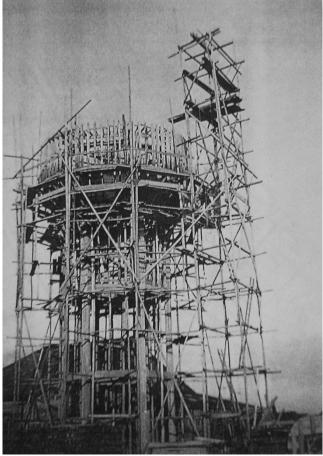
La construction du château d'eau de la cité girondine : tout un symbole (Source : archives privées Castors de Pessac)
